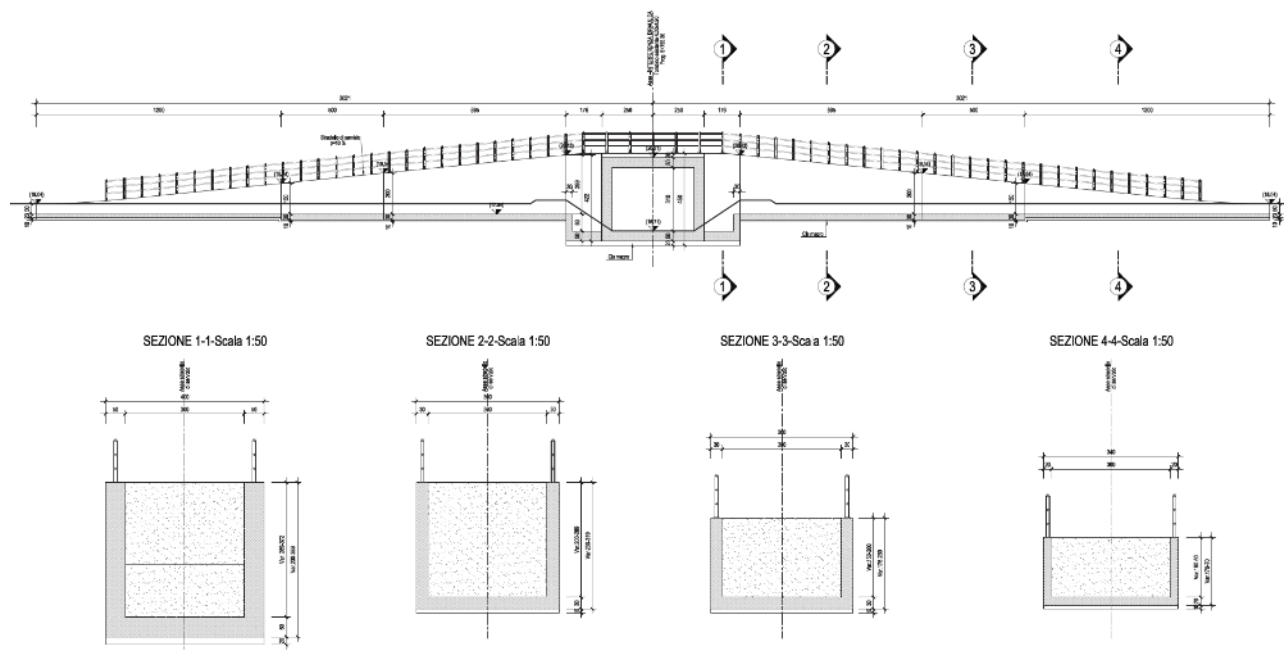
Ripristino stradello di servizio al Fosso Capoposta – Sezione longitudinale e Sezioni muro andatore ad “U”
